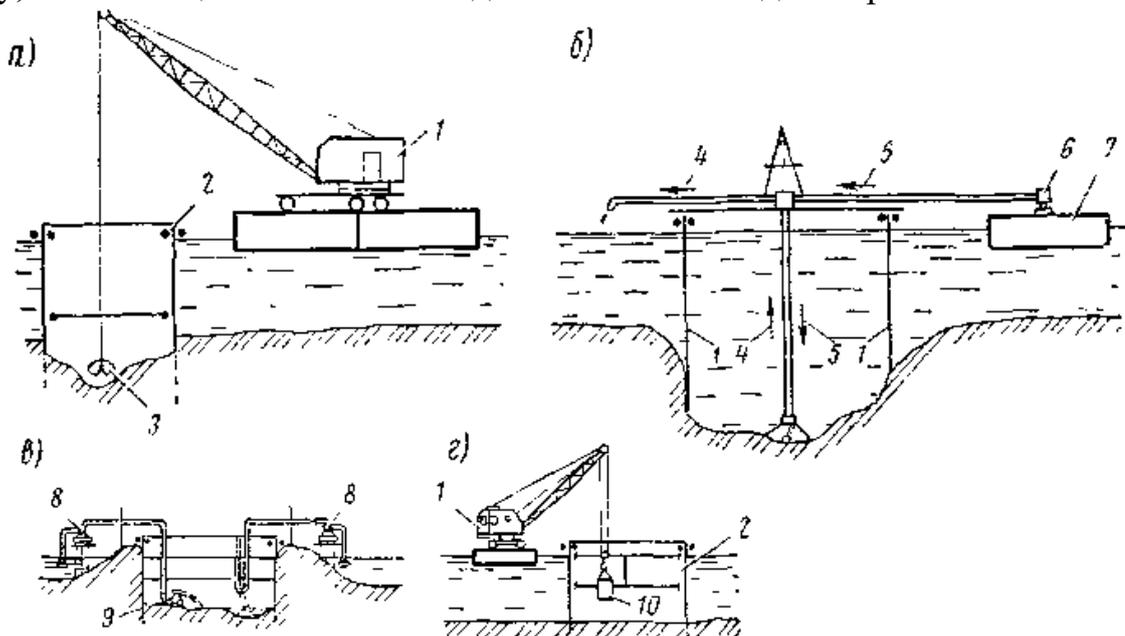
Схема разработки грунта из котлована: 1 – плавучий стреловой кран на понтонах, 2 – ограждение котлована; 3 – грейфер; 4 – направление движения пульпы; 5 – воздух, 6 – компрессор, 7 – понтоны, 8 – насос, 9 – гидромонитор
